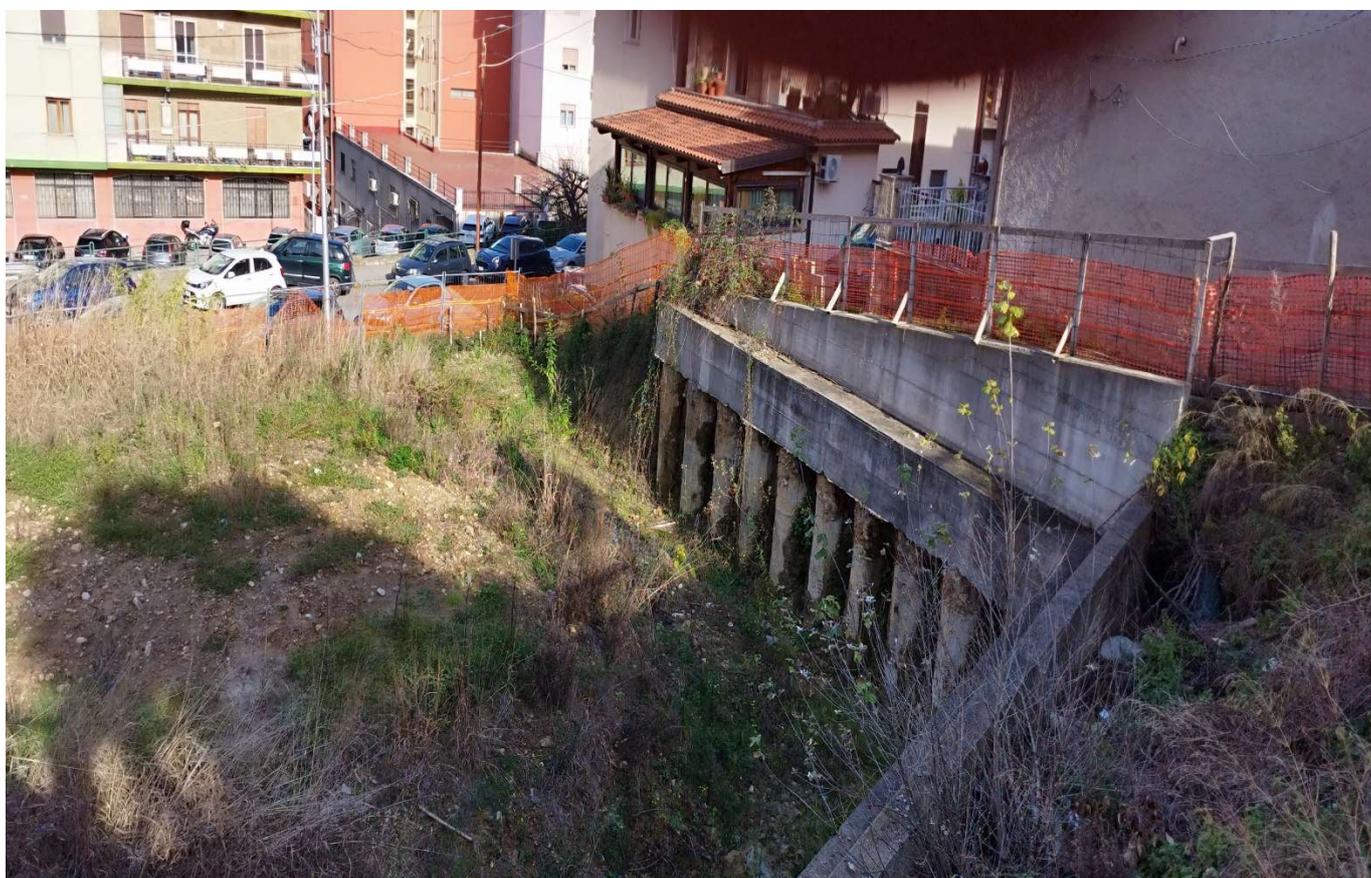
VISTA AEREA (DA NORD-OVEST) DELLO SCAVO CHE INTERESSA PREVALENTEMENTE LA P.LLA N° 1475;
